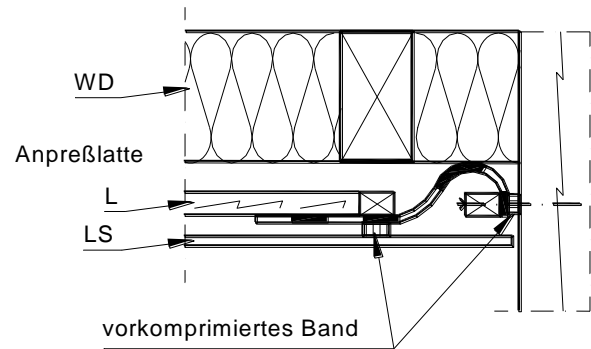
Anschluß Dachfläche an Holzbauwand [DIN V 4108-7]
